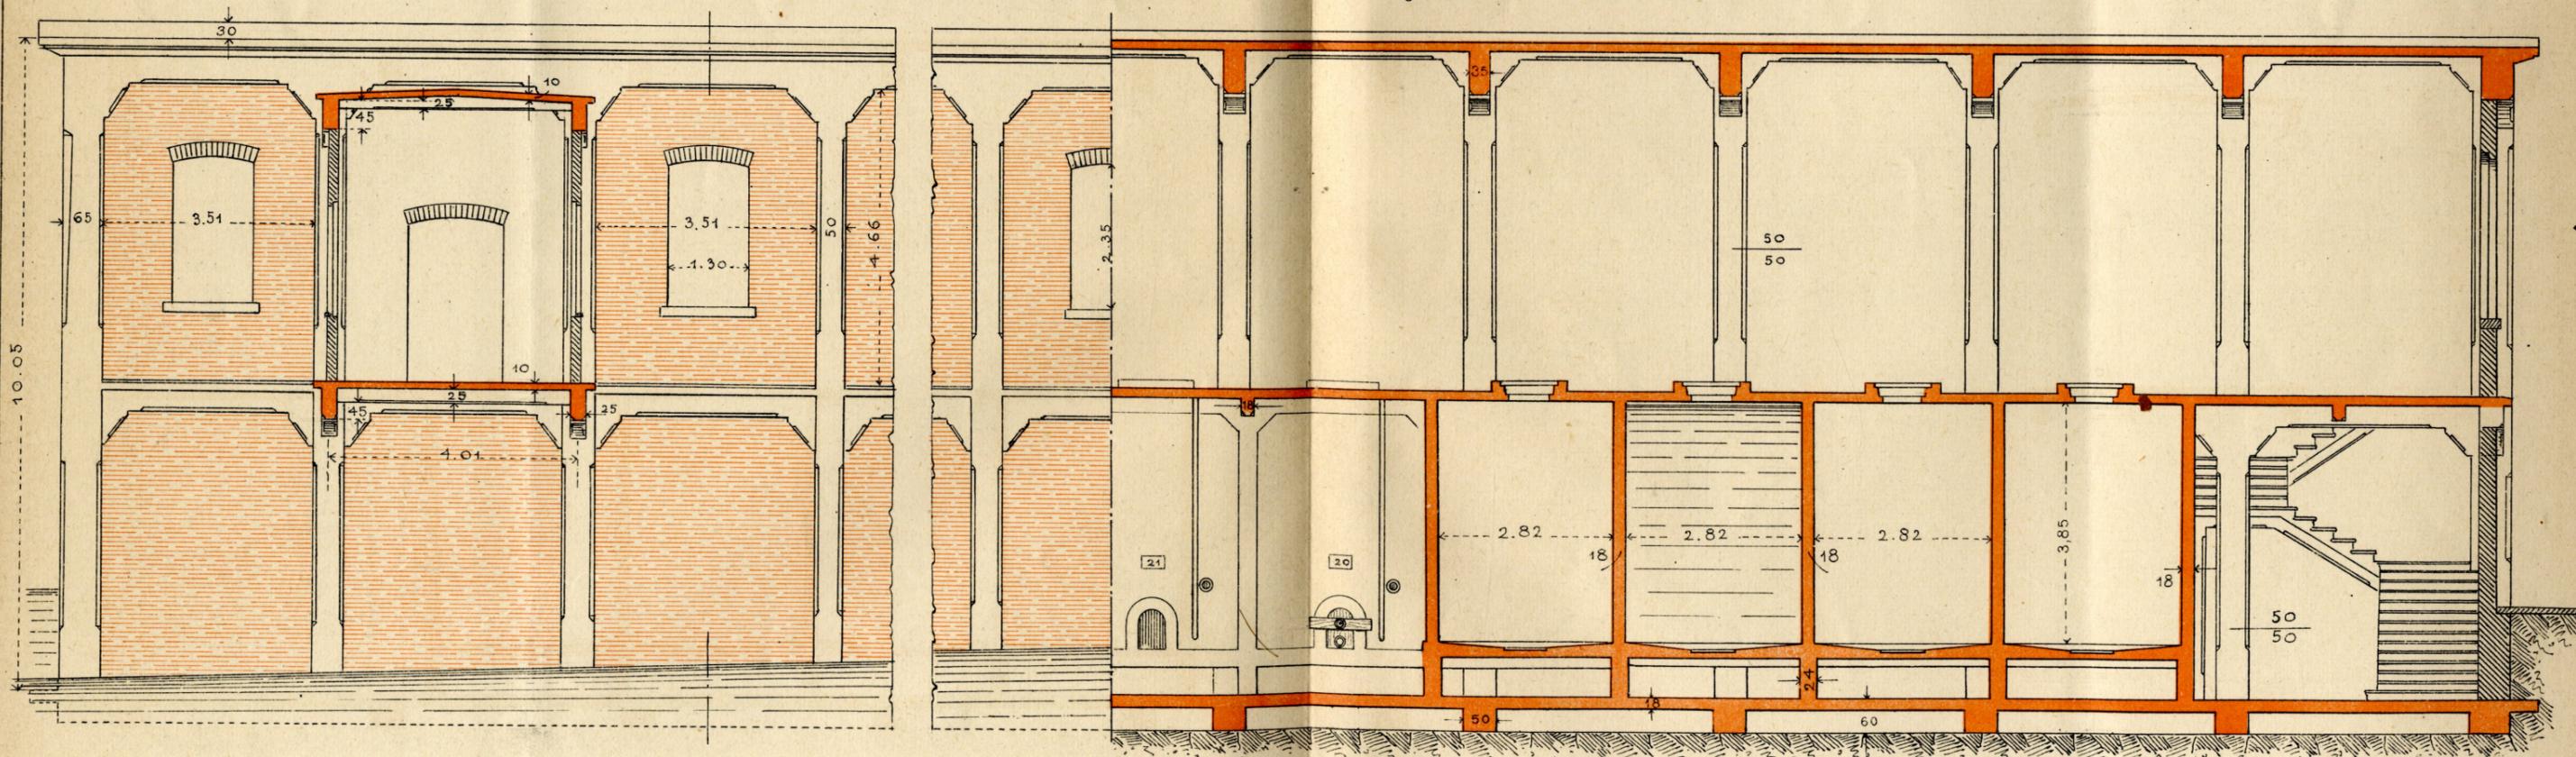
Saggio della elevazione di fianco e metà sezione longitudinale della cantina — Scala di 1:100
